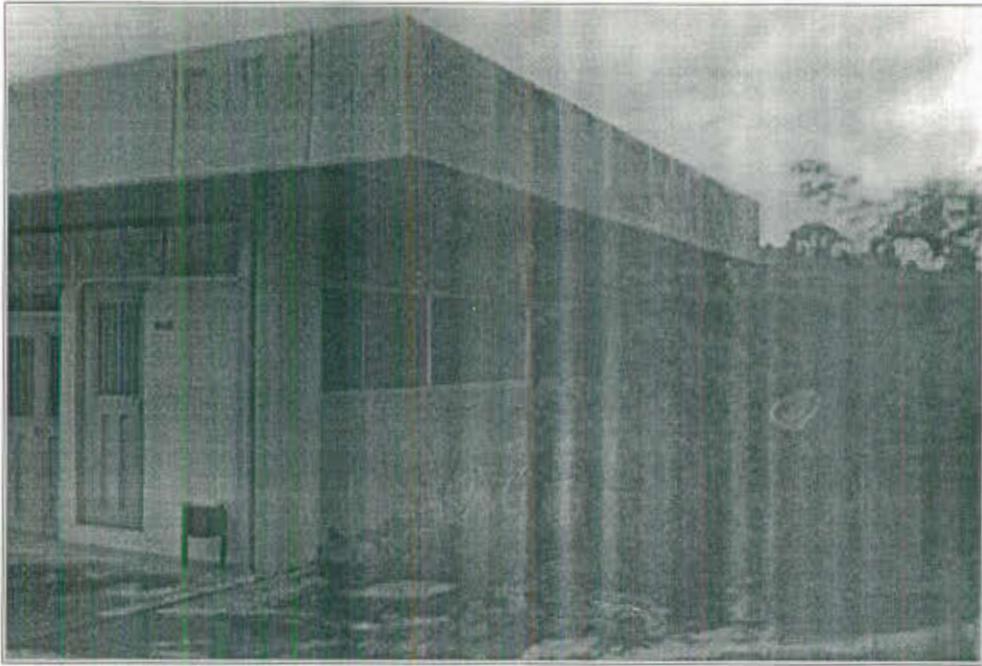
VISTA DE PLANTA ALTA DE EDIFICIO DE AULAS DE F.I.M.C.M.
